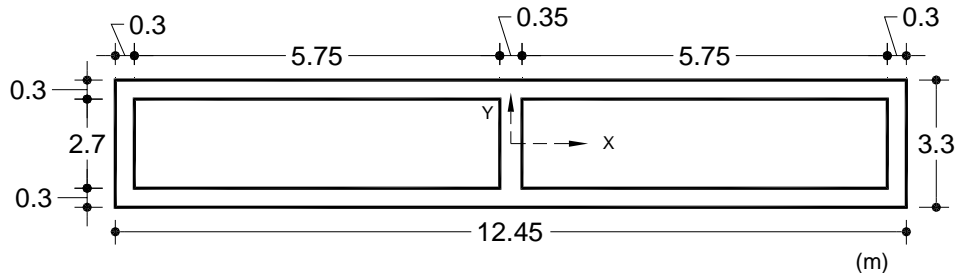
Sección 3 de la columna 4. (No. 7)
